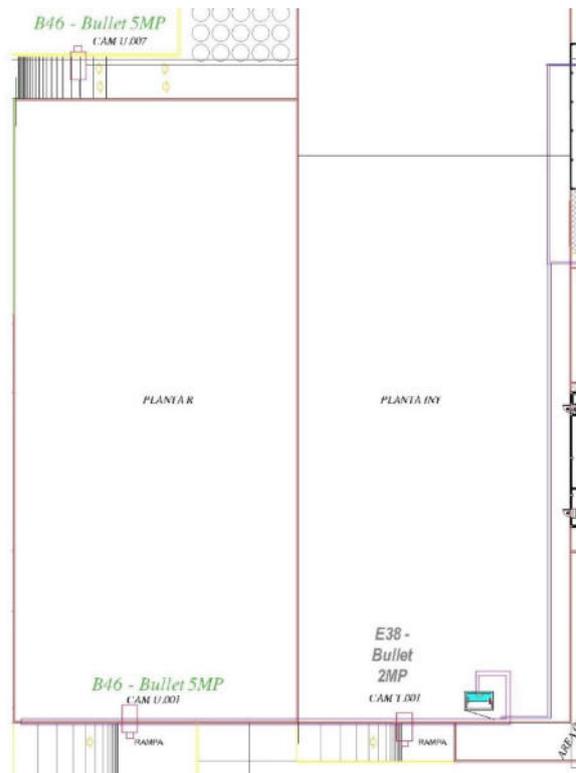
Ubicación de cámaras en la Planta R y Planta INY
